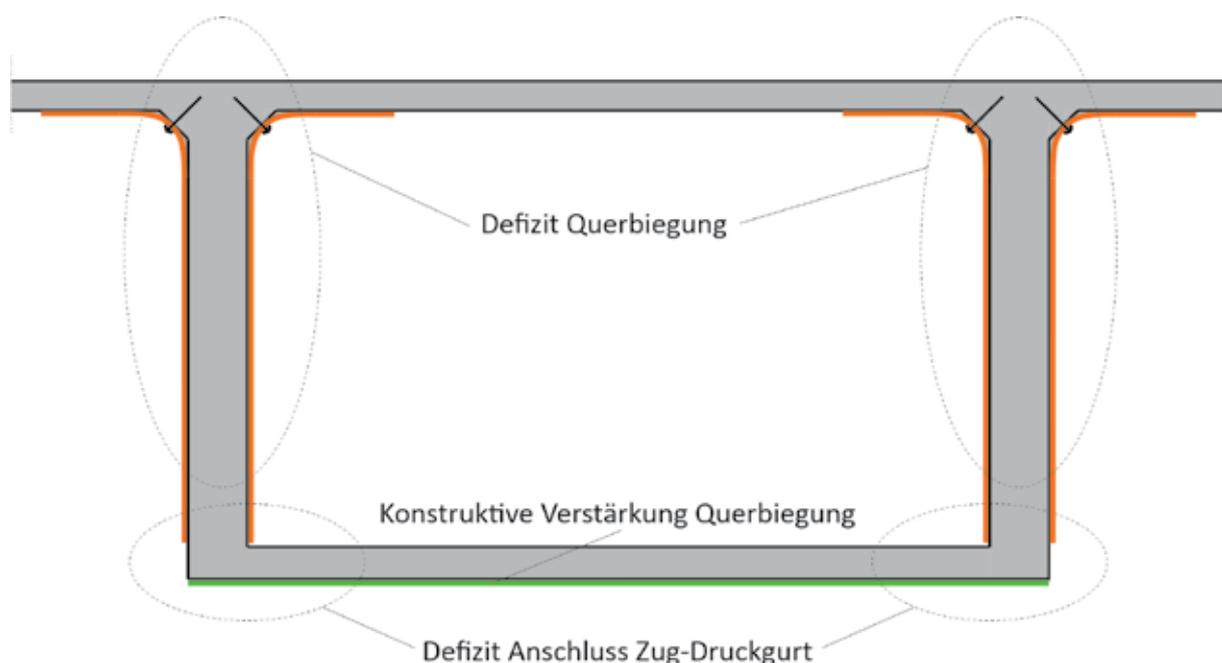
Prinzipiskezze Ertüchtigung Spannbetonhohlkasten
